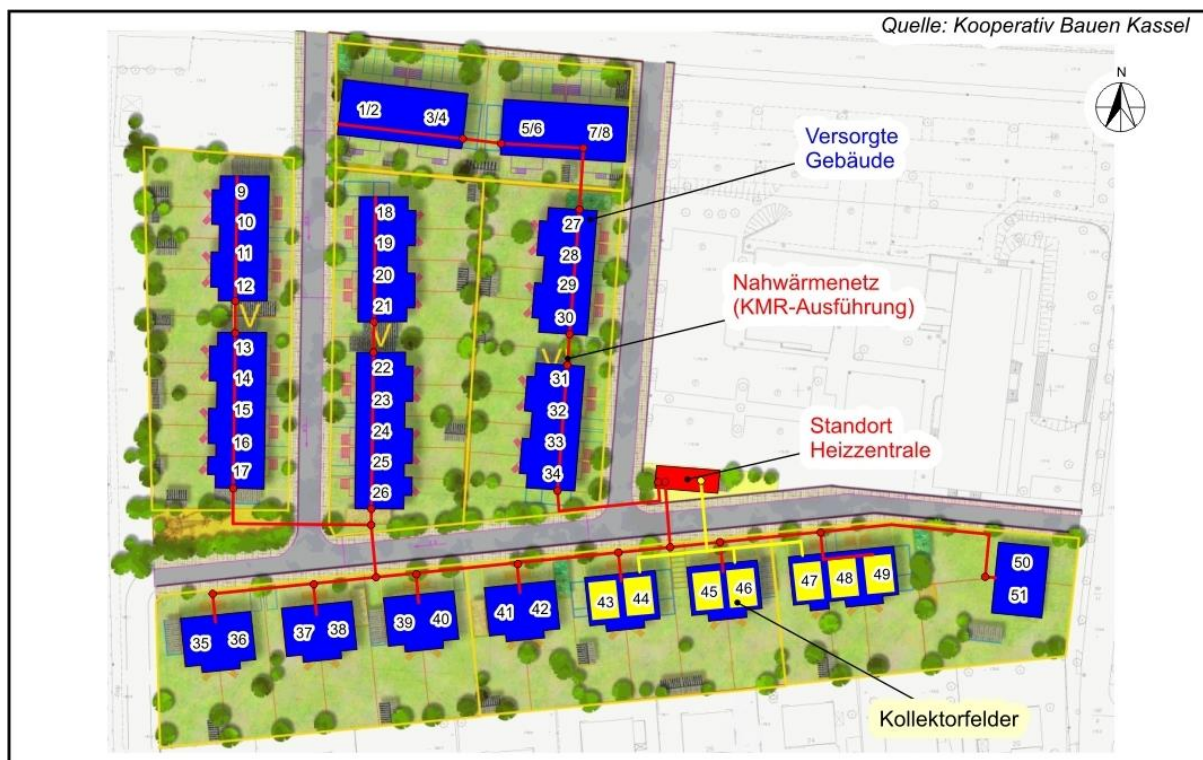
Lageplan Kassel Wehlheiden, Neubaugebiet Sternbergstraße
